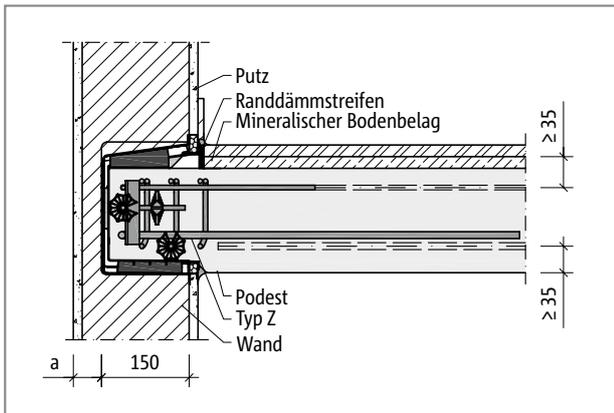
Schöck Tronsole® Typ Z: Brandschutzausführung
